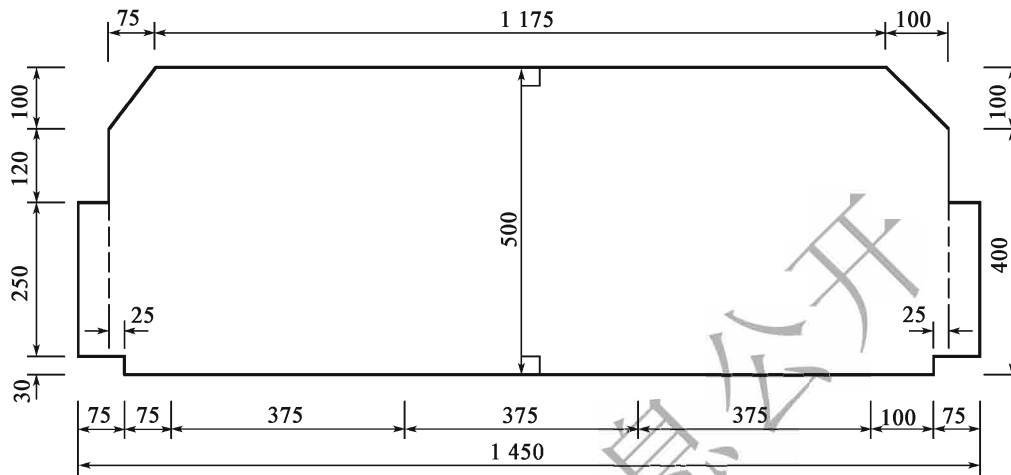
Dégagement de construction du tunnel autoroutier et du tunnel routier de première classe à trois voies (100km/h) (unité: cm)
